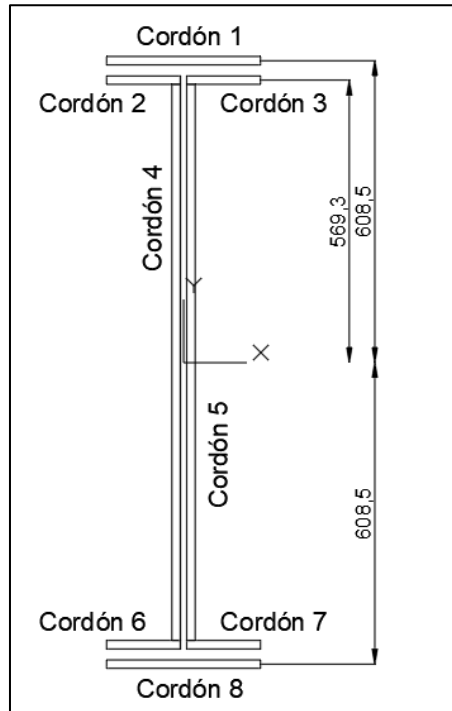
Esquema de unión soldada planteada. Fuente: Autor.
